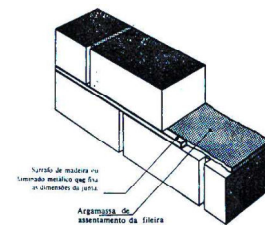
Junta em parede de tijolo face-à-vista [5]
